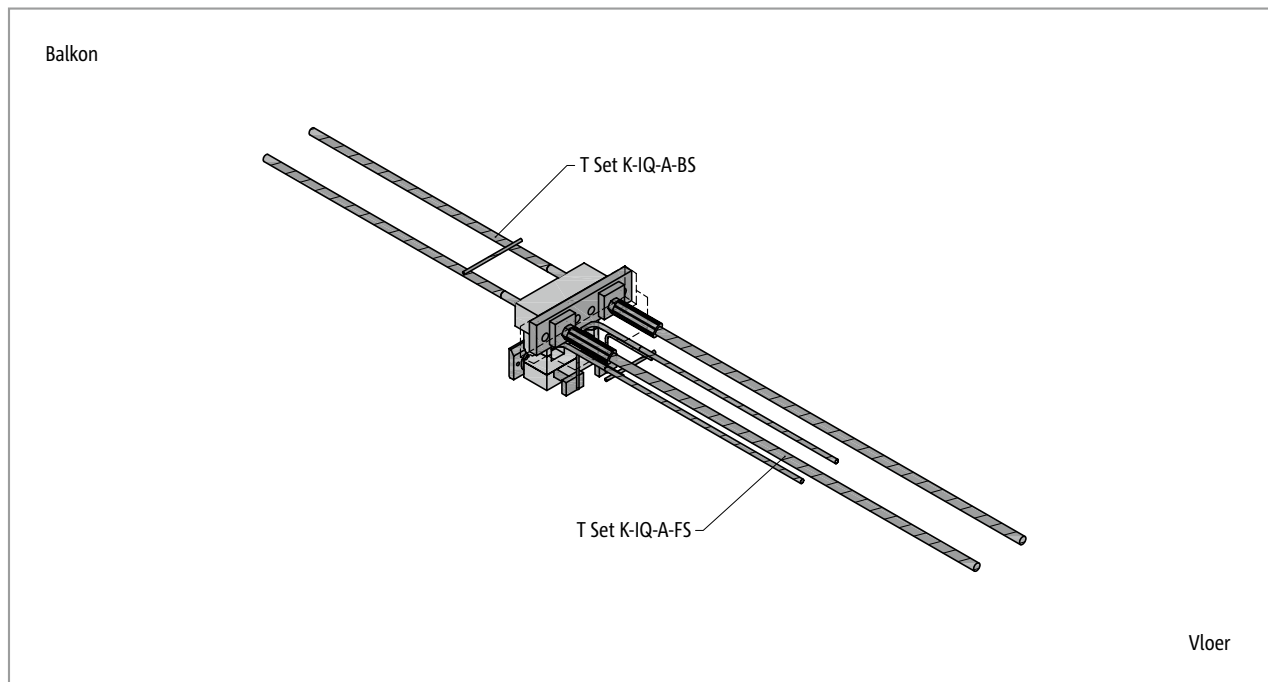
Schöck Isokorb® T type K-IQ: Plaatsing met hoogteverschil
